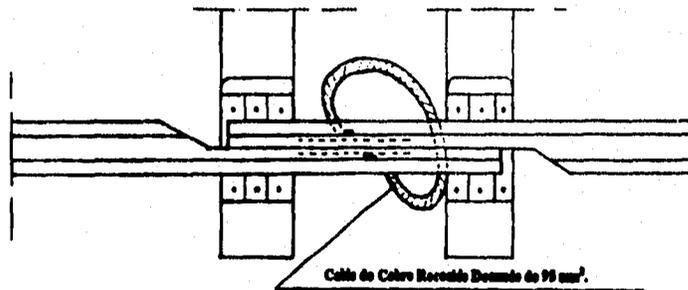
Cable para Conexión por Aparato de Dilatación.
